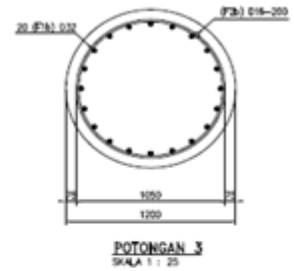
1 Detail Tulangan Pondasi Bore Pile
